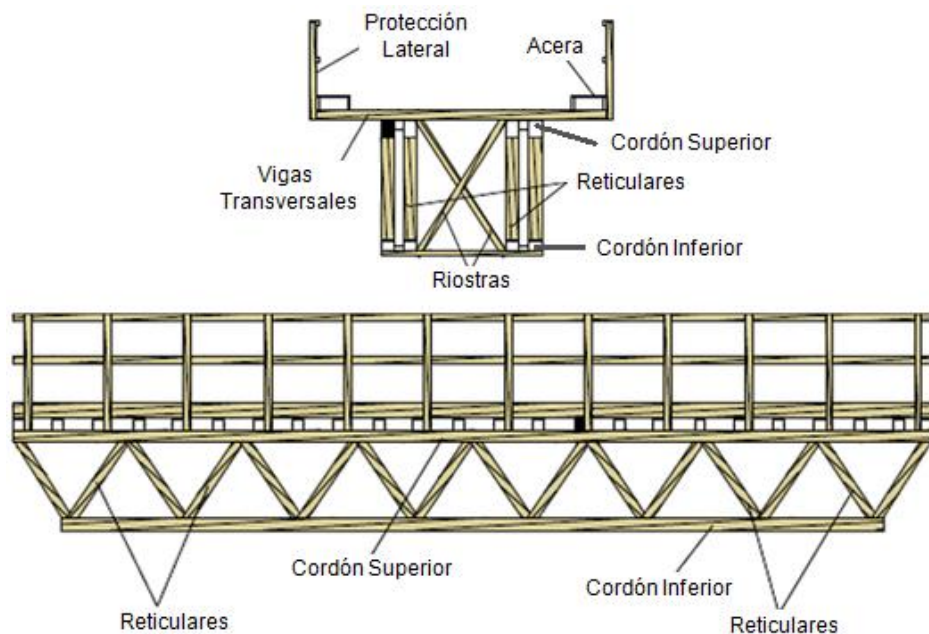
Secciones transversales con vigas en celosía tipo Warren [14]
